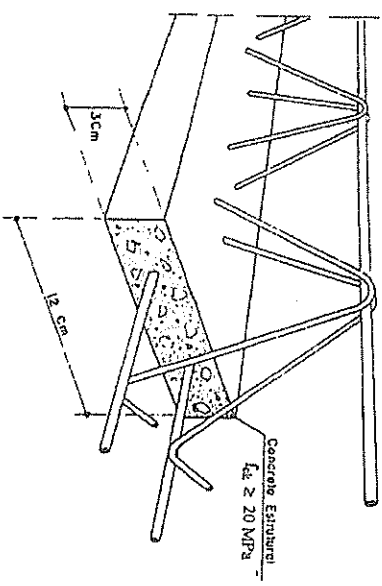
Laje nervurada com vigas pré-moldadas
